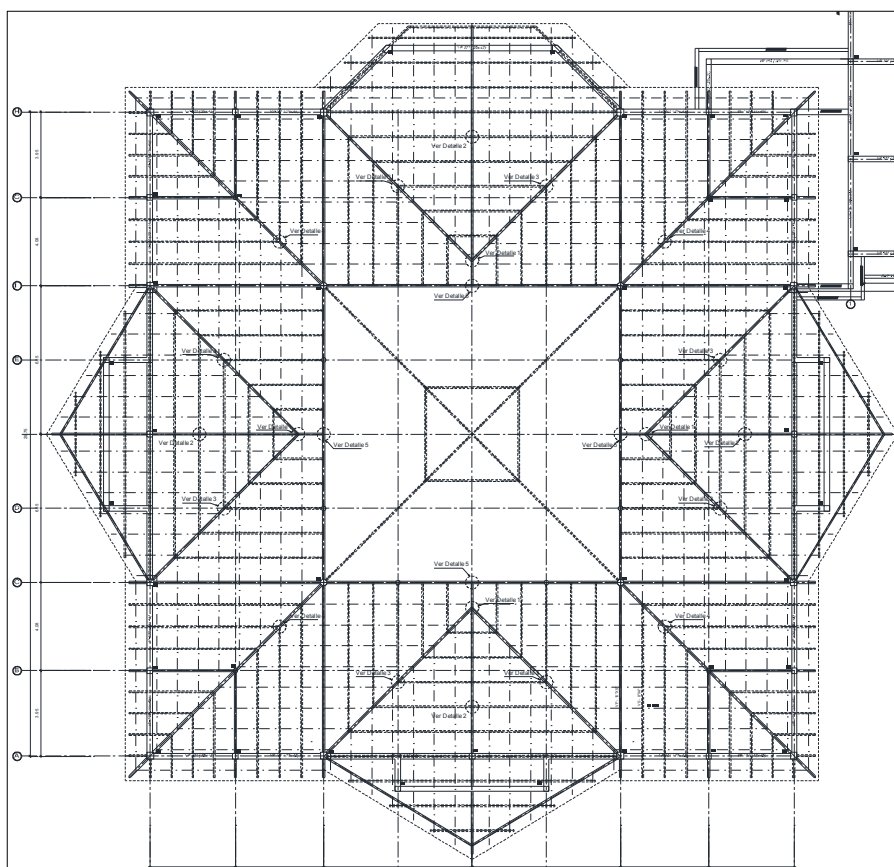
PLANO DE LA ESTRUCTURA DEL TECHO DEL RESTAURANTE
